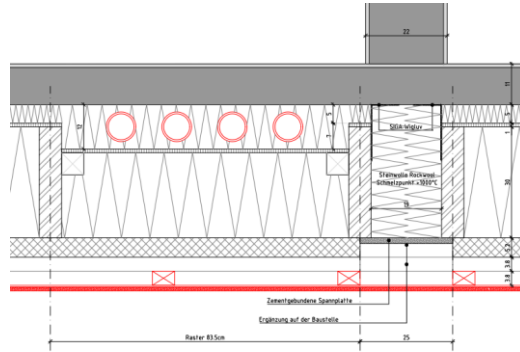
Raccord entre panneaux (coupe horizontale)
